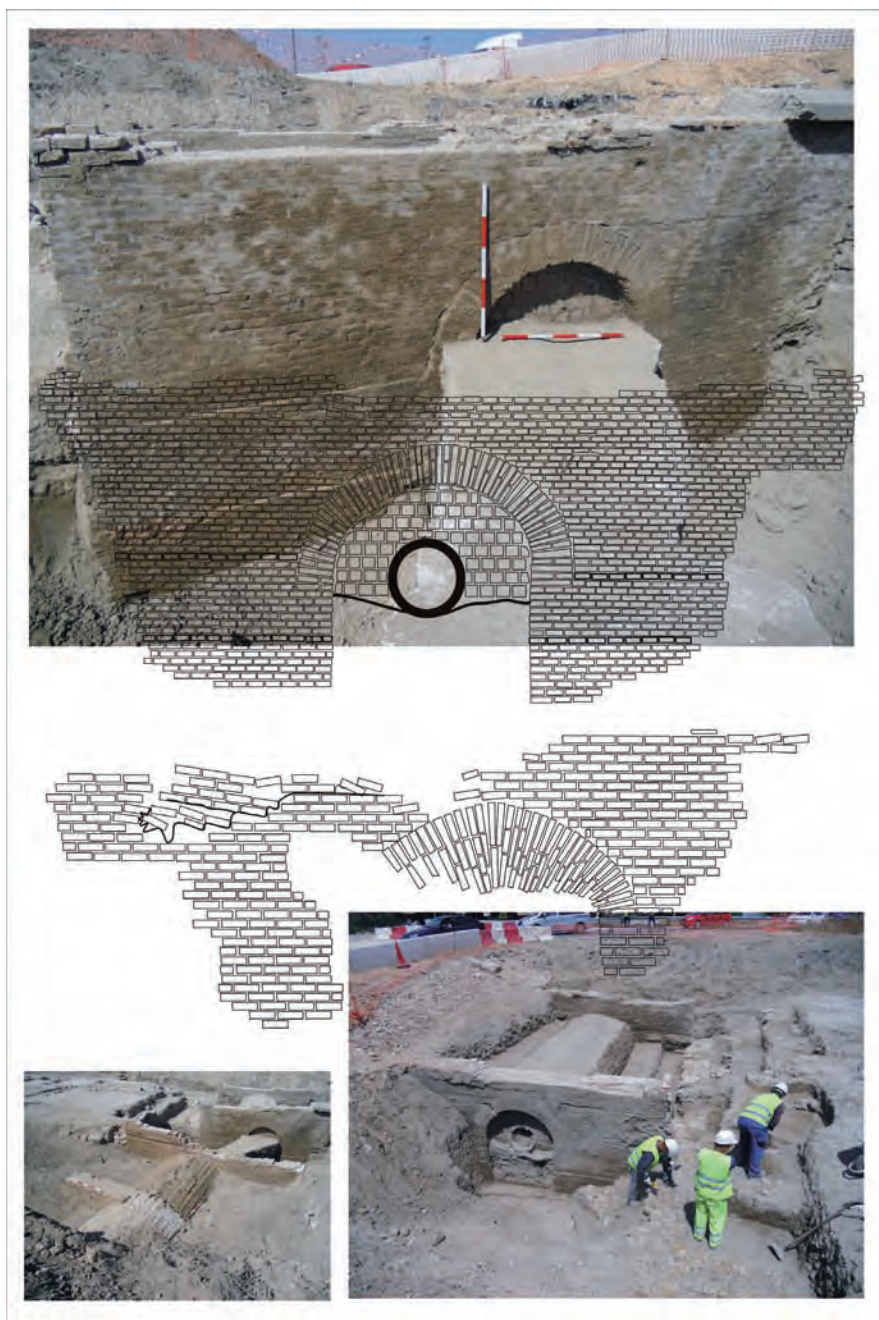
Detalle del puente 1, alzado del puente 1 aguas arriba, alzado del puente 2, detalle de la caja correspondiente a la plataforma del puente 2 y vista de general del puente 2.
